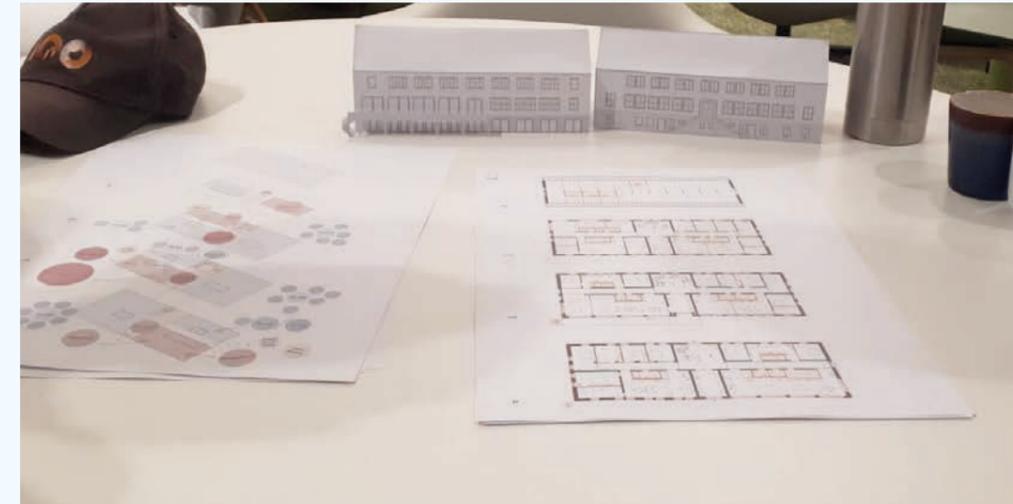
Besprechung der Grundrisse, eigenes Foto
